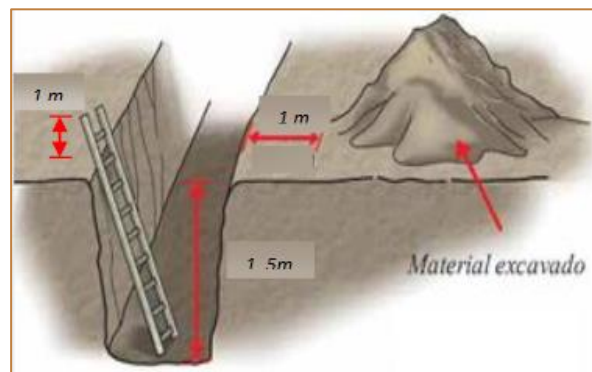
Seguridad en la ejecución de obras de alcantarillado
